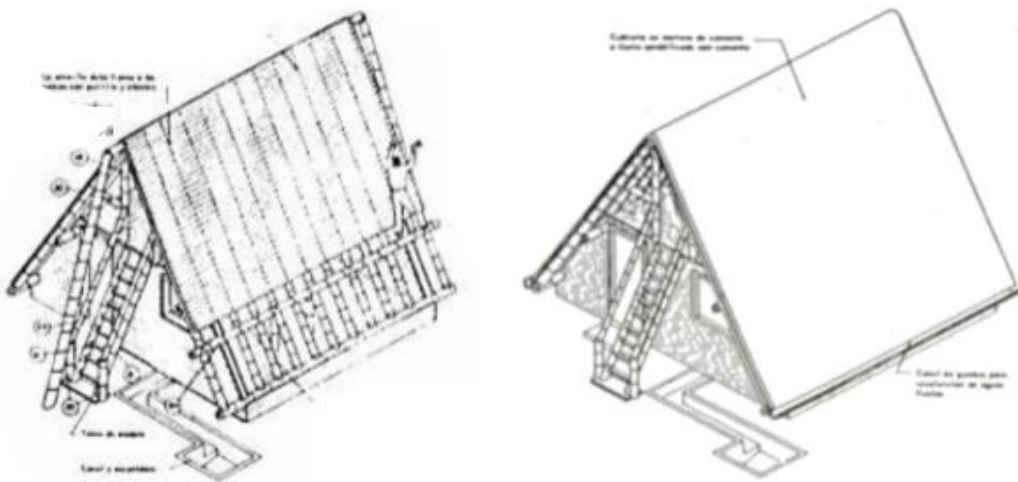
Vivienda terminada. Fuente: Deva, S. 2006.
